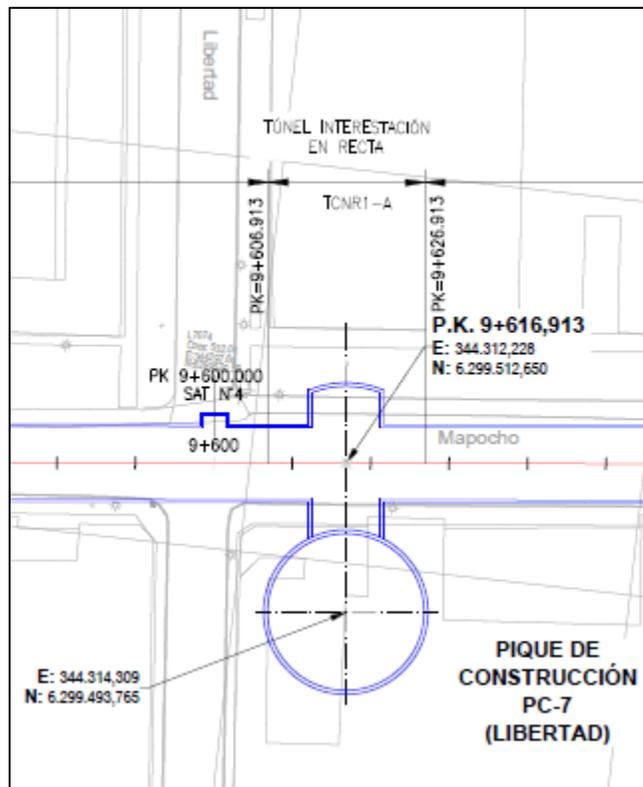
Planta Emplazamiento Pique Construcción Libertad
